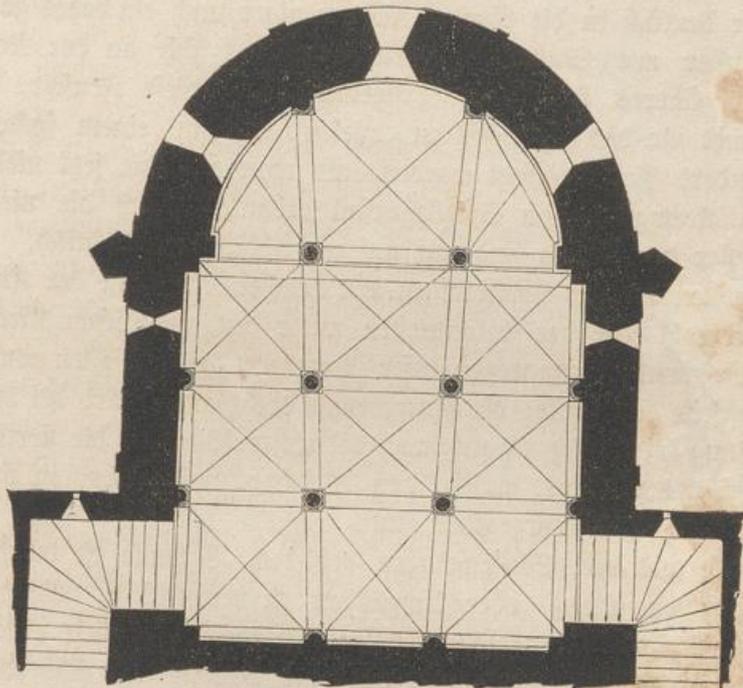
Grundriß der Krypta der Kirche zu Laach.
